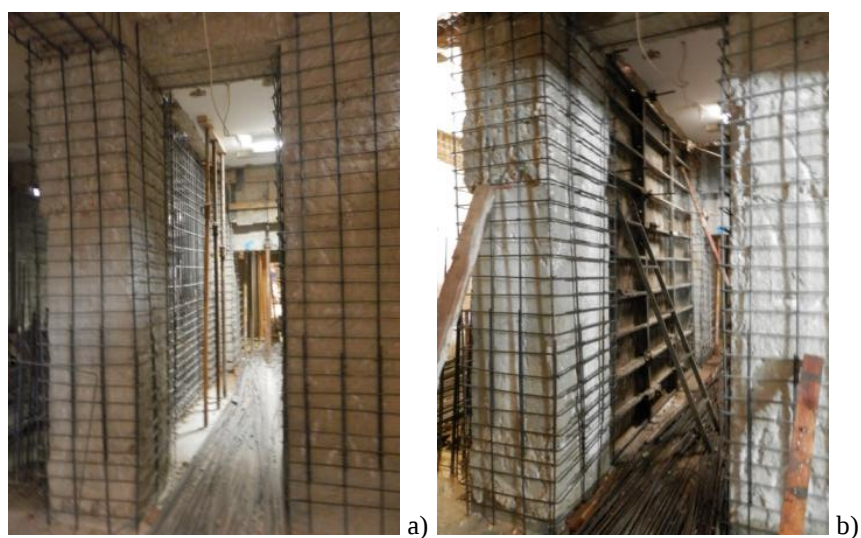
Parede resistente PB4: a) armadura; b) cofragem metálica
